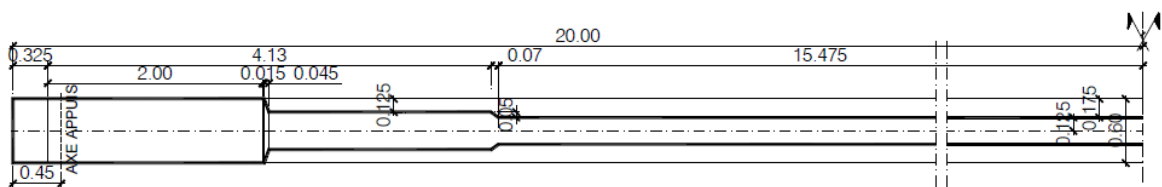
coupe longitudinale de la poutre (L/2)
